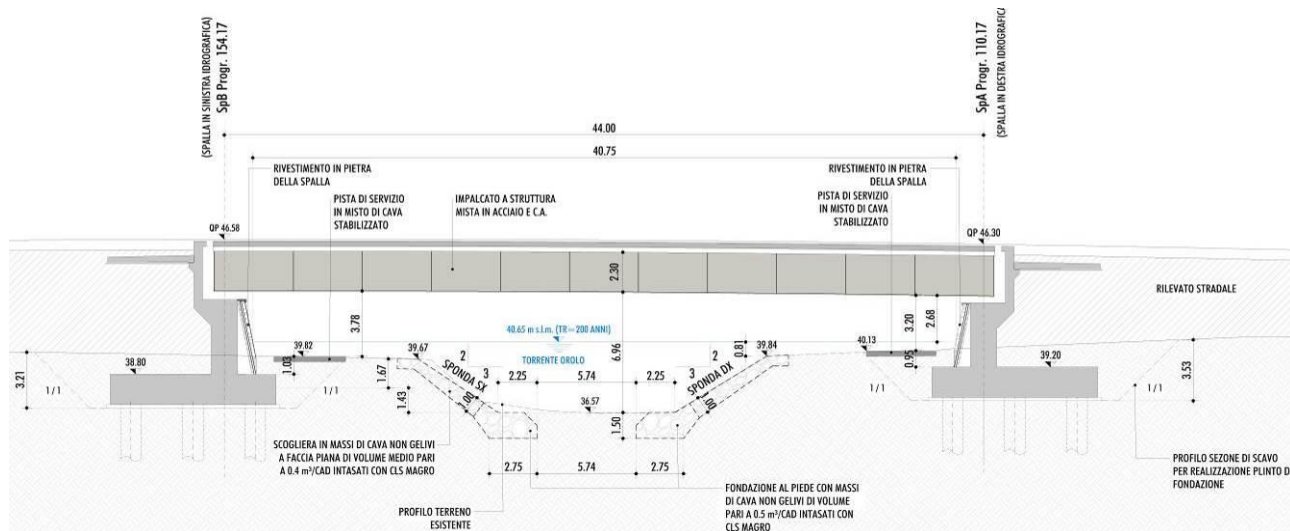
SEZIONE LONGITUDINALE PONTE SUL TORRENTE OROLO
